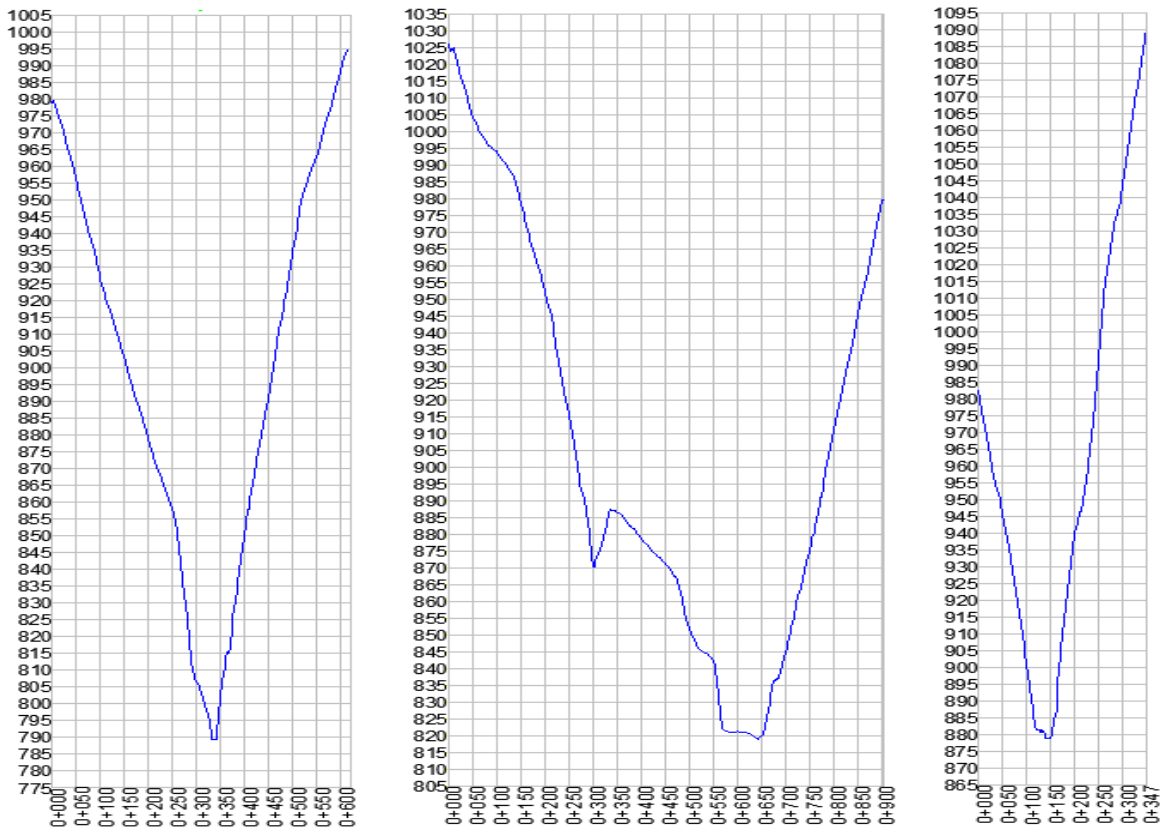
Muestra de Secciones Transversales para la parte alta, media y baja del proyecto.
